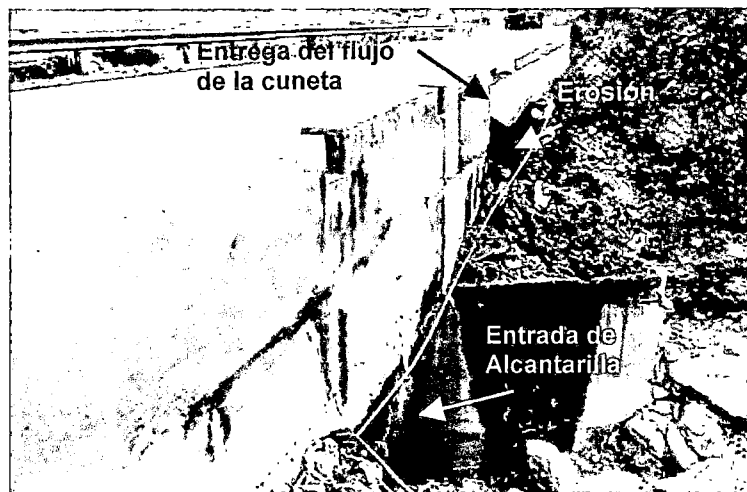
Se observa que el flujo que llega de la estructura de drenaje longitudinal a la estructura de drenaje transversal, produce erosión alrededor de la estructura de drenaje transversal (Km 2+460 de la Carretera La Oroya – Pte. Matachico).
